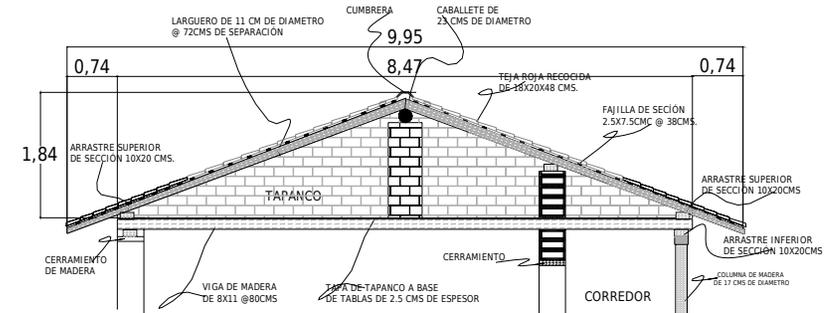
DETALLE DE LA CUBIERTA Y LA ESTRUCTURA DE LA VIVIENDA TIPO.
